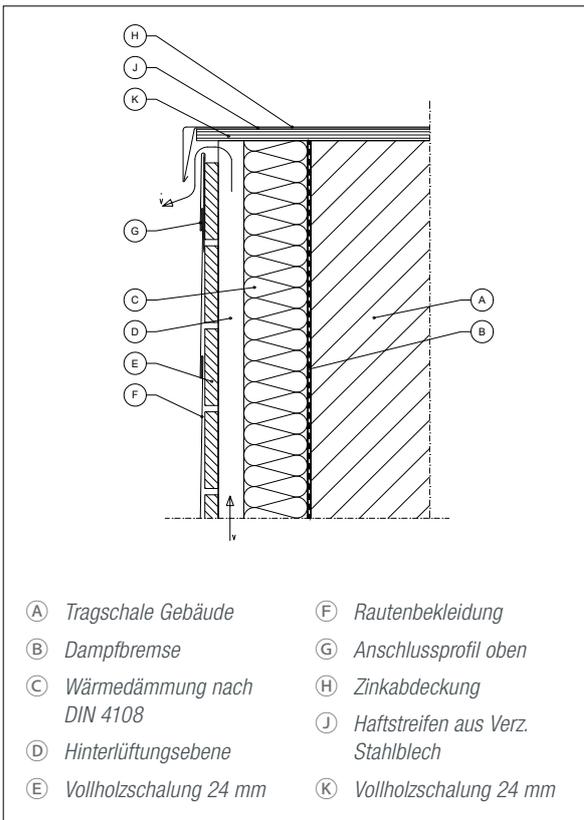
Rautensystem Fassadenanschluss oben
